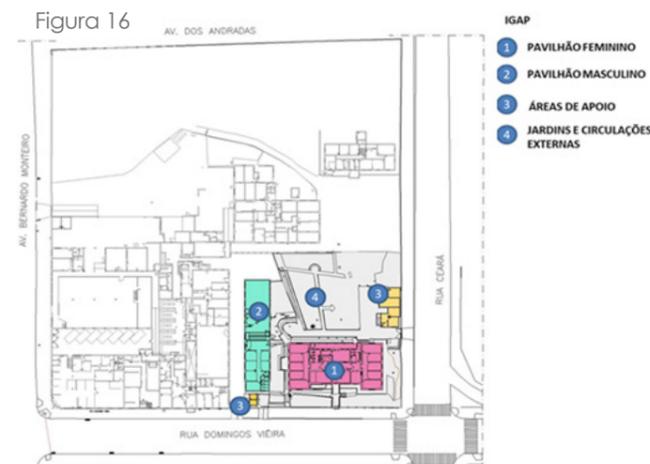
Planta de situação - Pavimento térreo – IGAP
